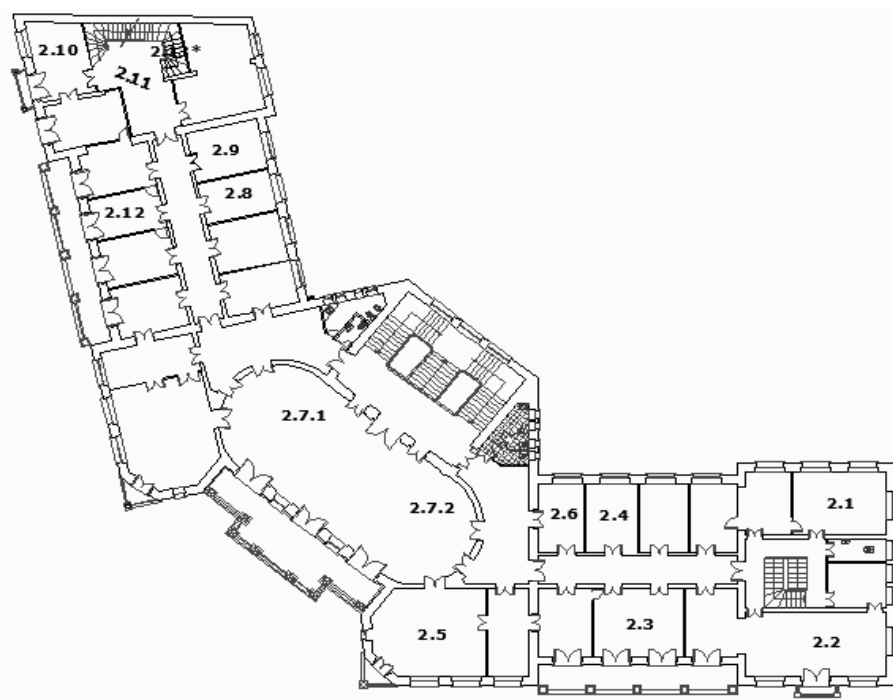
Localização dos pontos de medição em planta, Piso 1.
